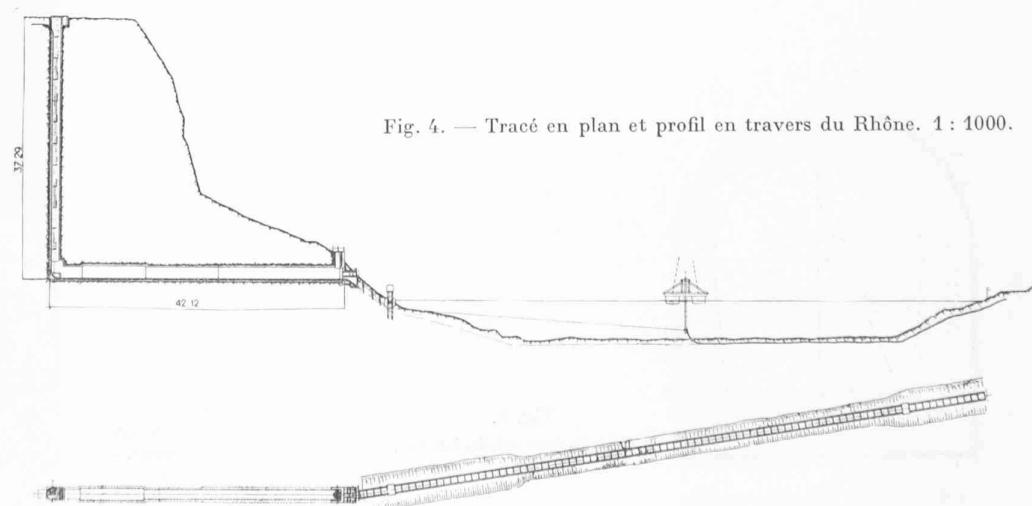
Tracé en plan et profil en travers du Rhône. 1 : 1000.
